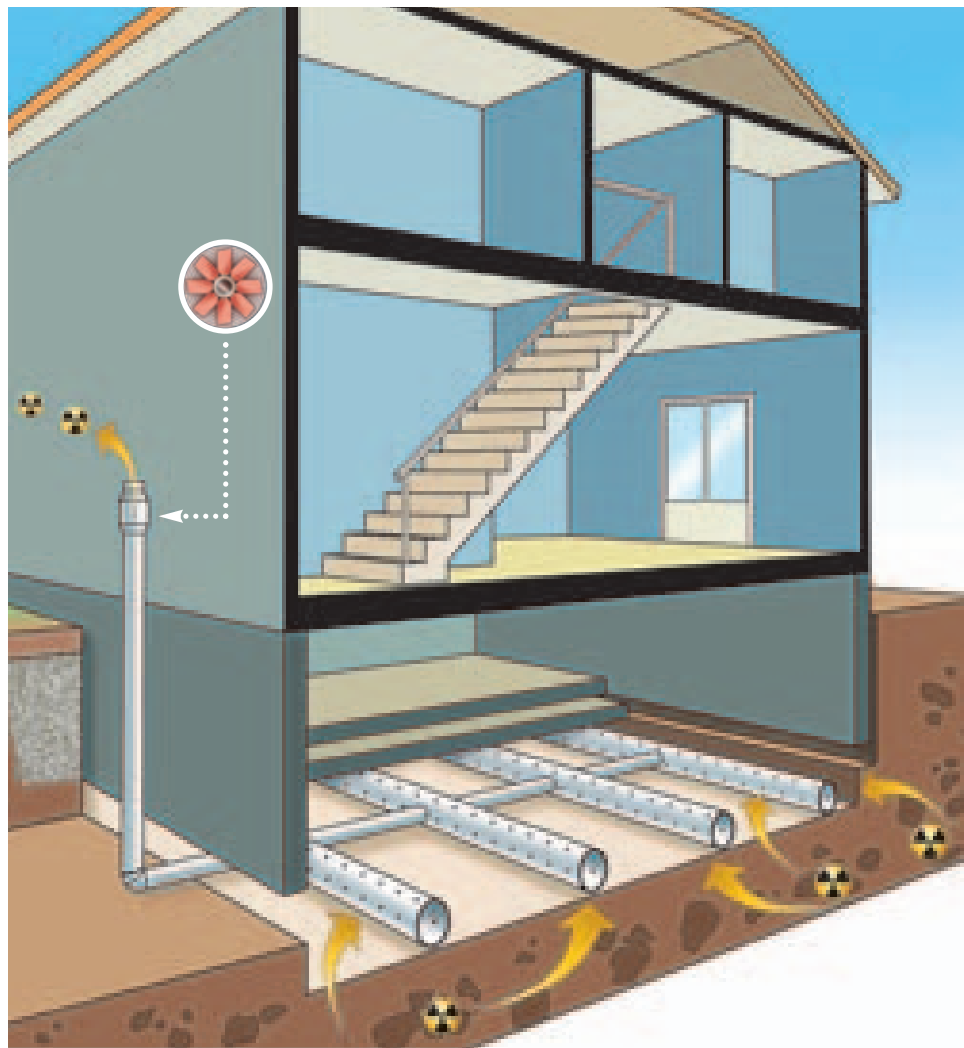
Casa con fondazione a platea impermeabilizzata all'ingresso del radon. Nell'esempio riportato all'impermeabilizzazione è stato abbinato un sistema di drenaggio (collettori posti sotto lo strato di ghiaia ventilato).
